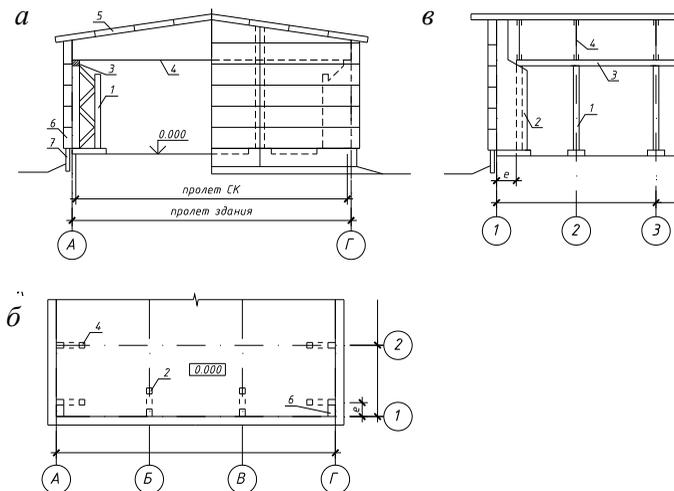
Здание со сквозными колоннами (привязка нулевая):
